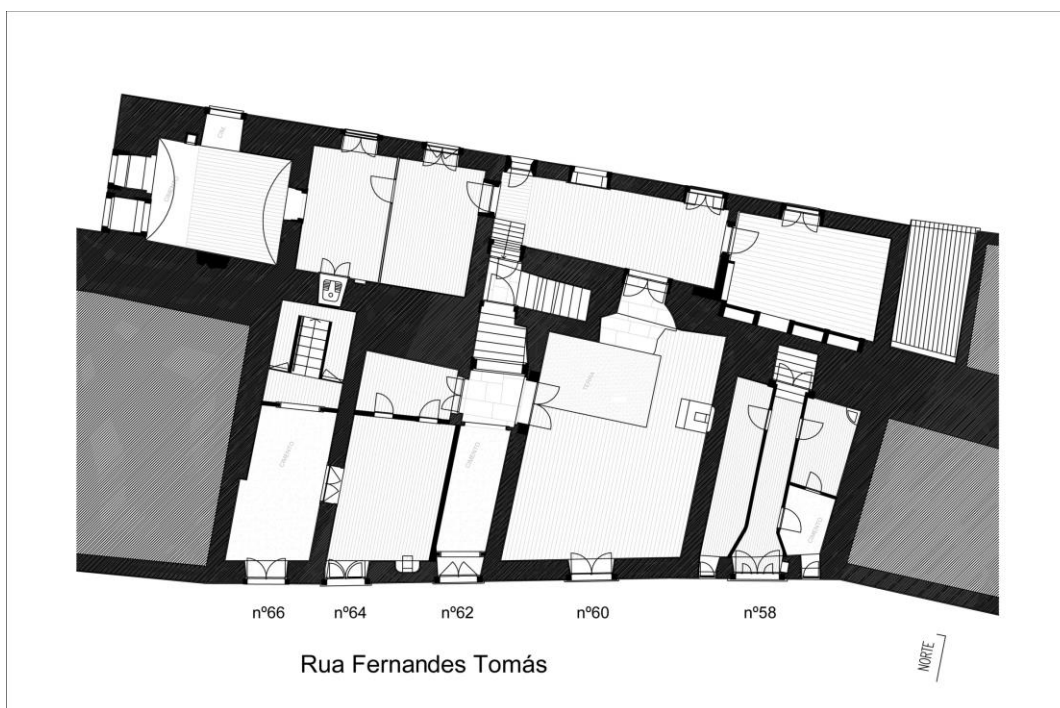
Planta baixa rés-do-chão: Casa das Talhas – Esc.: 1:125
